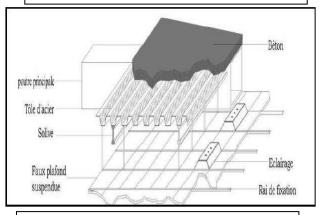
détail de plancher collaborant./Source : les auteurs.
